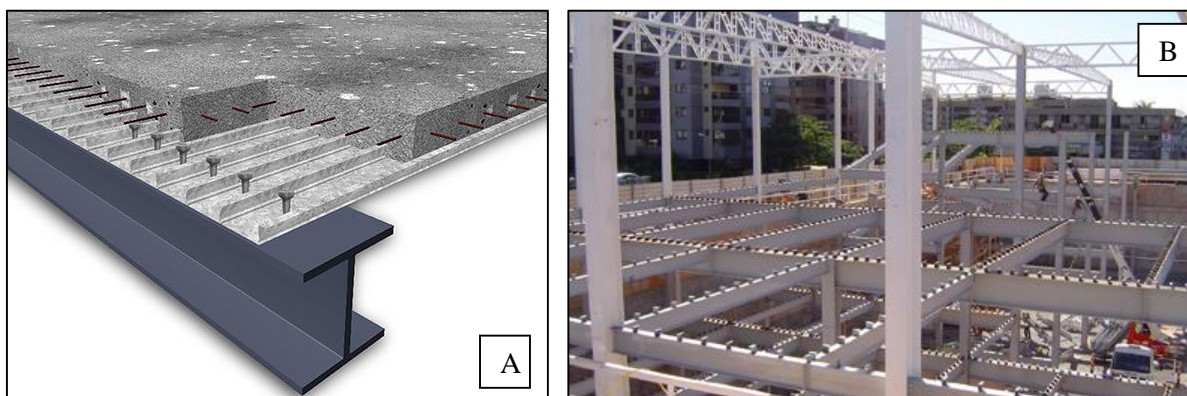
Esquema (A) e estrutura em execução de sistema misto aço e concreto (B)
